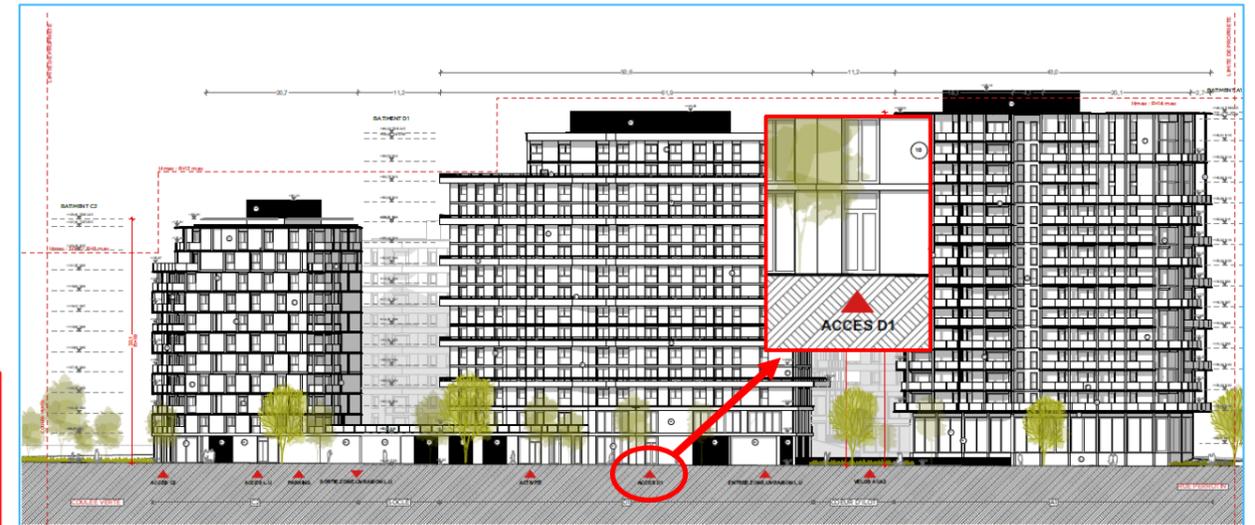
Coupe longitudinale de la rue Perrotin (Source : PPX Architecture)
